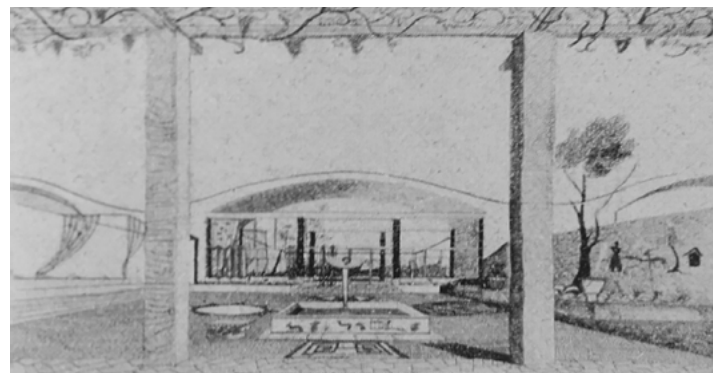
Progetto dell'arch. Furio Fasolo, schizzo prospettico di una delle aule; via MORETTI, 1942
